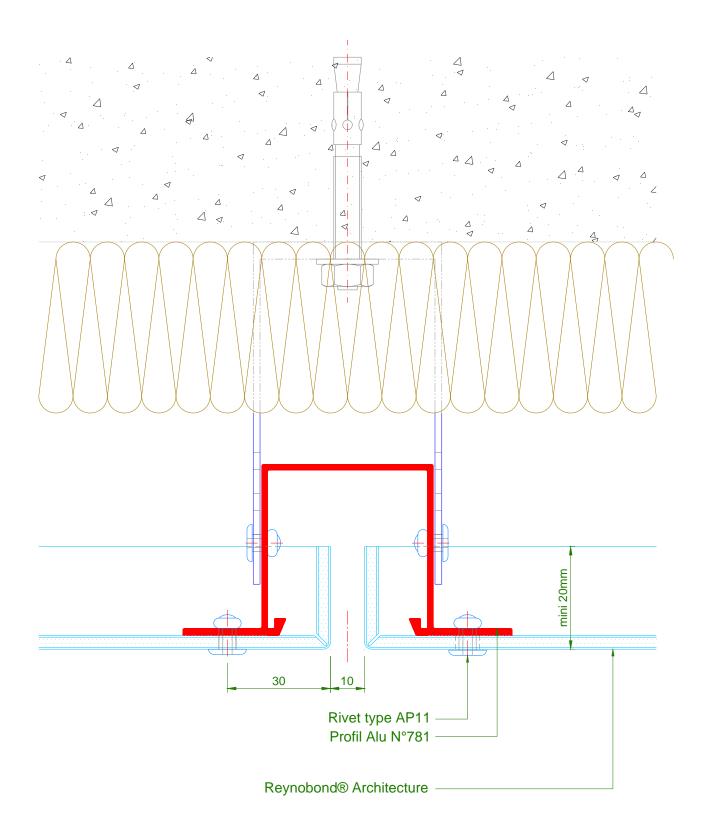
er – Joint vertical - Coupe horizontale – Système riveté RV 50 2c - Avec plis de renfort
